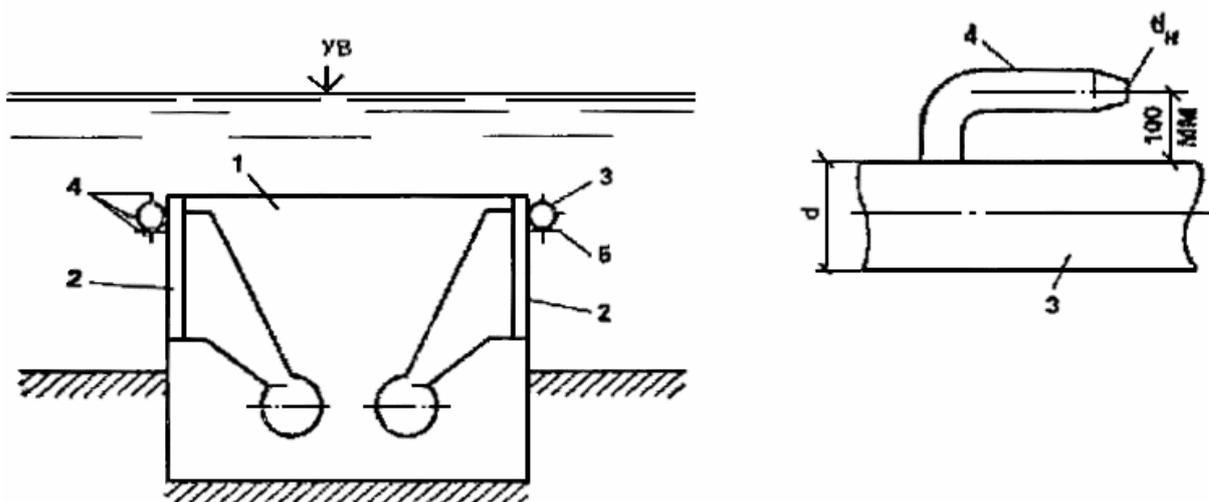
Схема размещения распределительного водовода на водоприемнике и присоединение насадка
